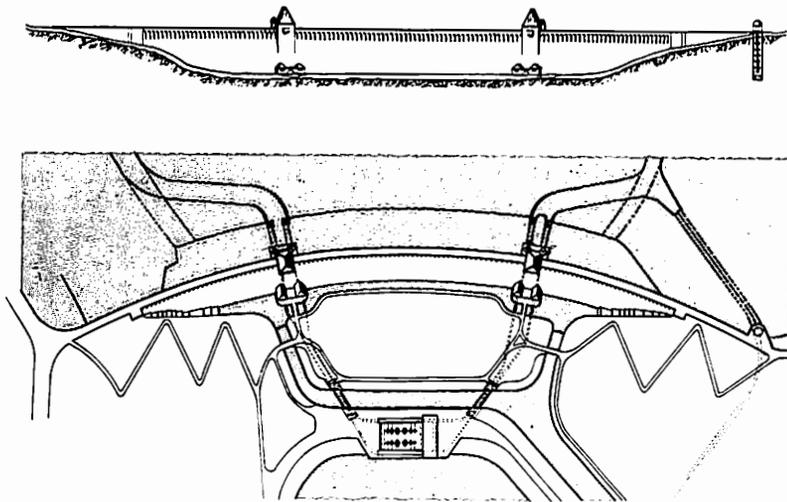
Ansicht und Grundriß der Stauanlagen mit dem ehemaligen Kraftwerk
